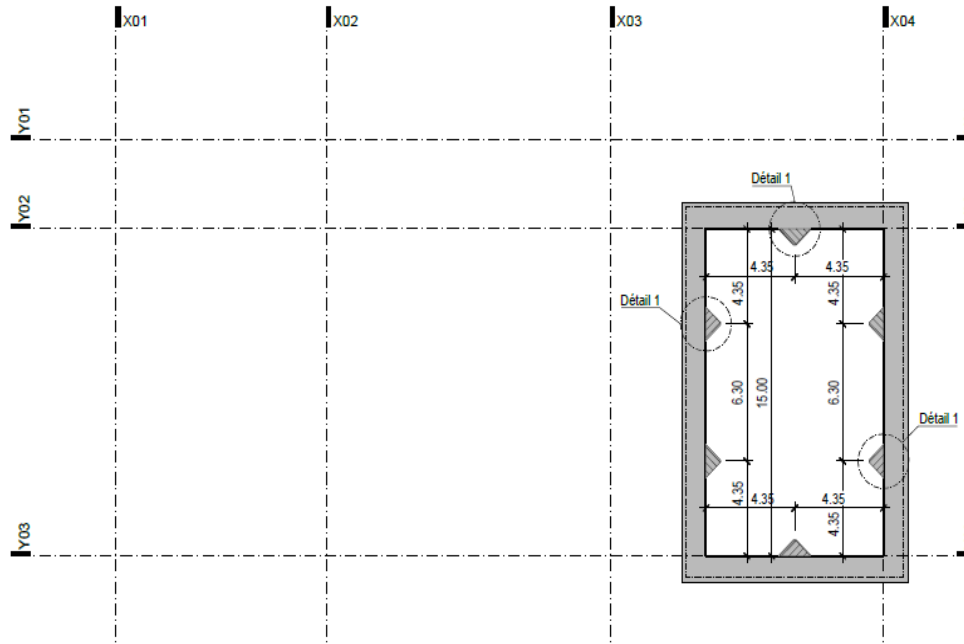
Vue Plan Au Niveau +3.10 (Poutre 3 Et Massifs D'appui)
